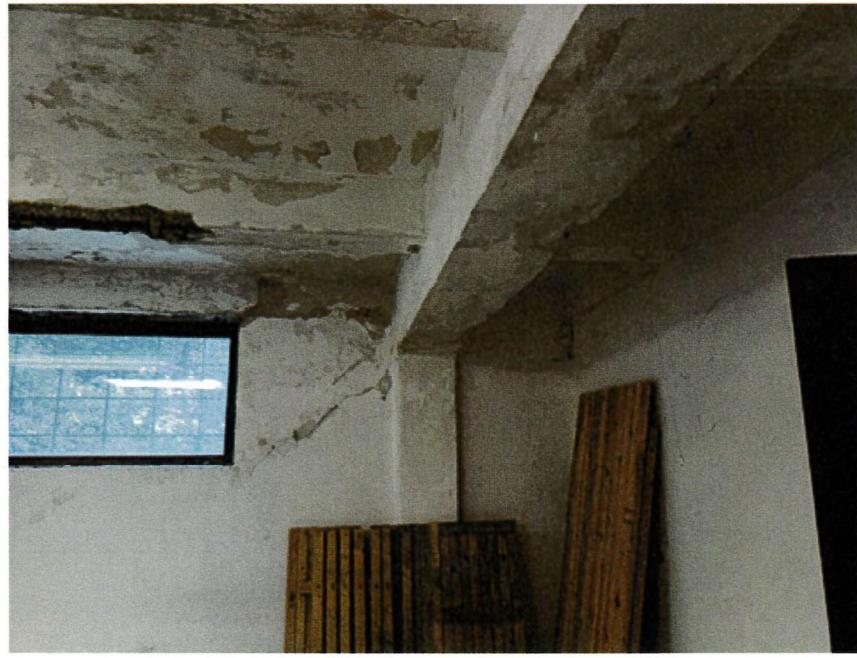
Styk stropního trámu a průvlaku a napojení sloupu
